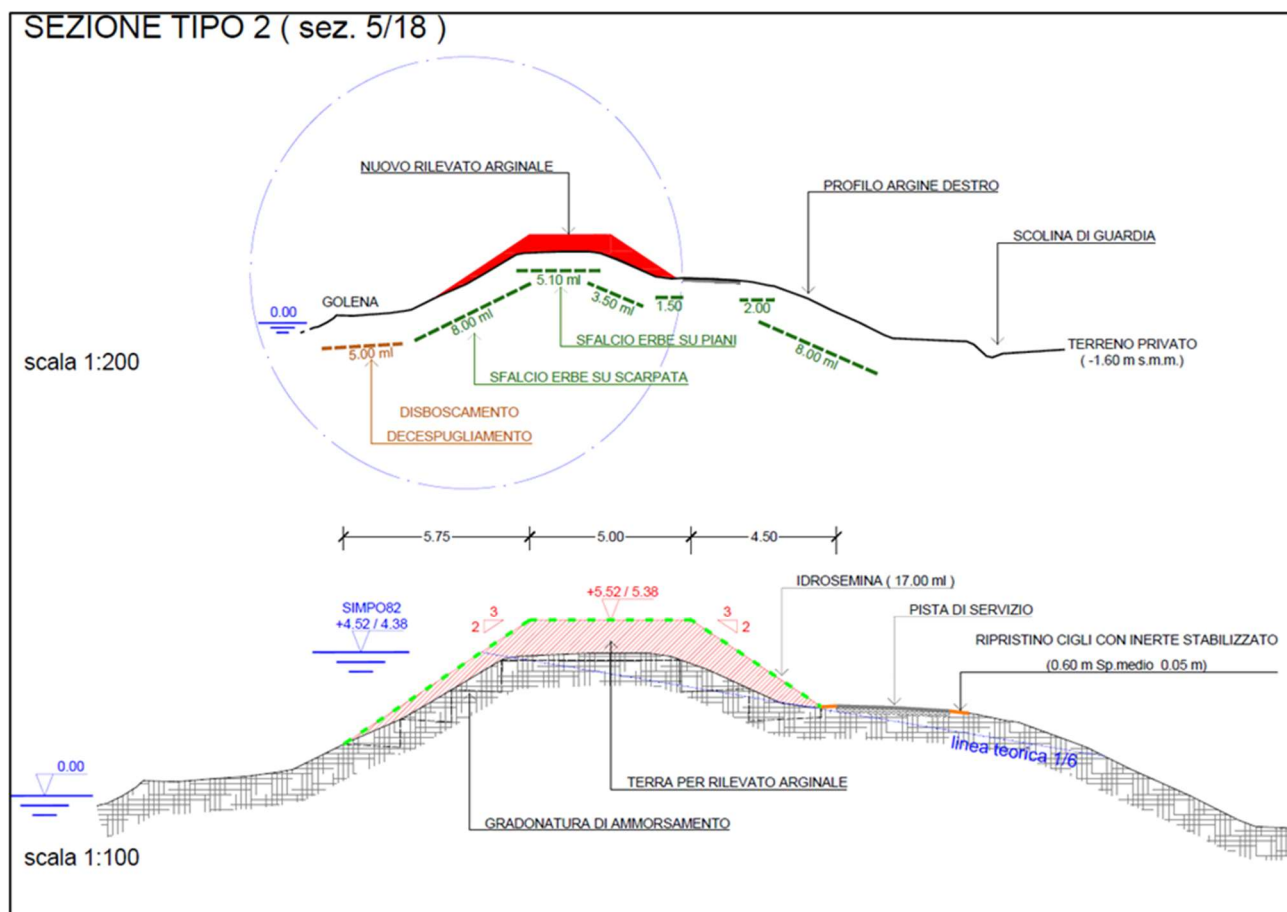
Sezione Tipo n° 2 (estesa prevalente)
